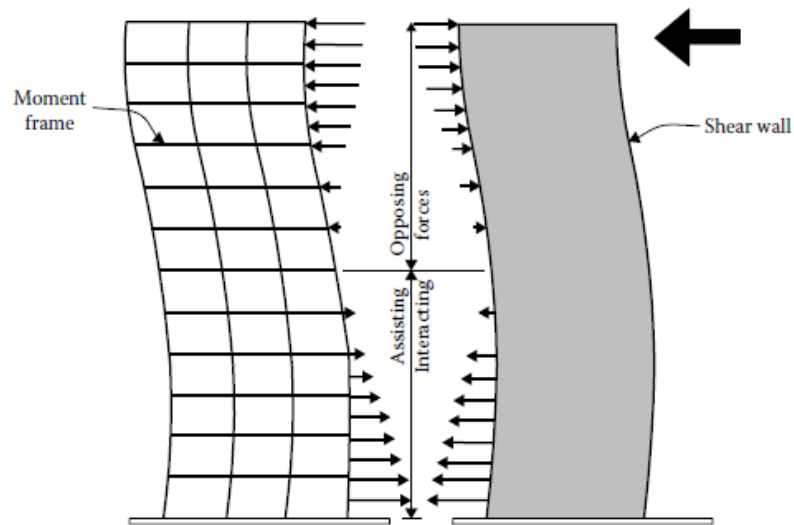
Interacción de sistema pórtico a momento con muros de corte
